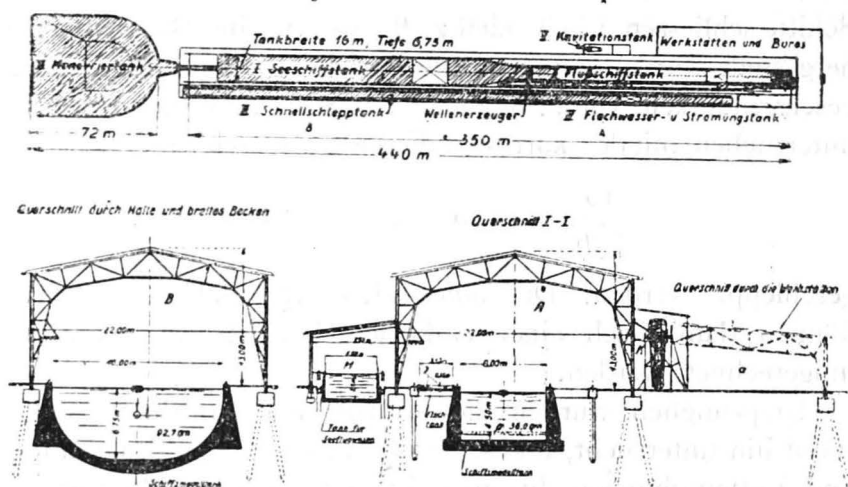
Grundriss der Hamburgischen Schiffbau-Versuchsanstalt.
